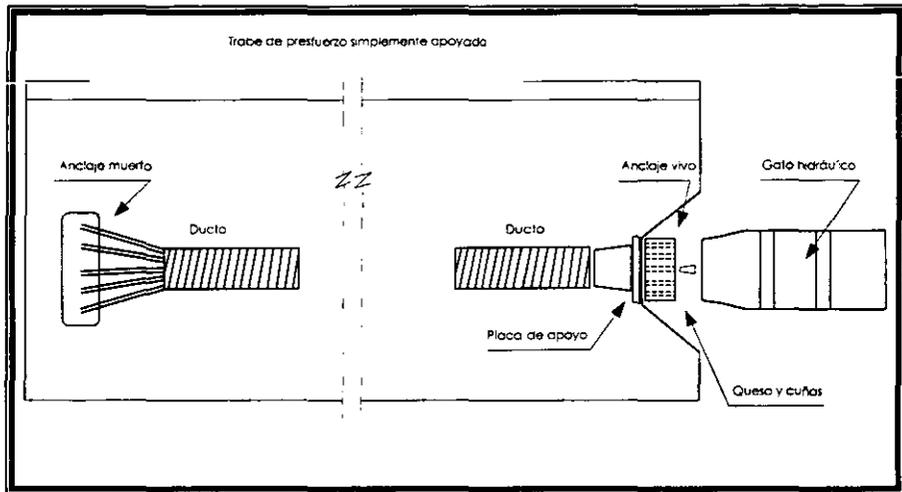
Accesorios para la aplicación del preesfuerzo.
